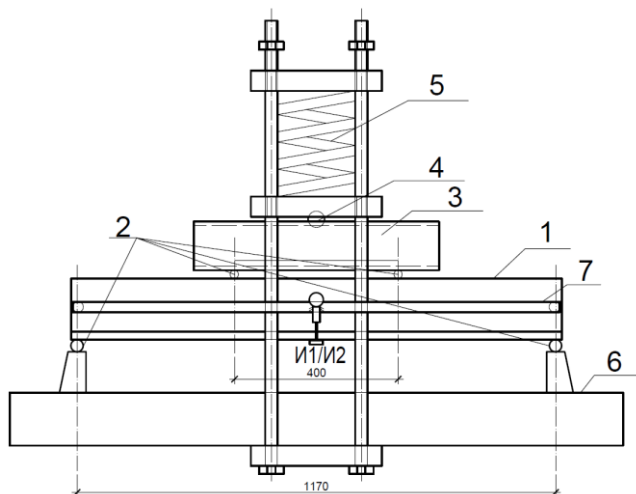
Схема установки для проведения испытаний на изгиб при длительном действии нагрузки:
